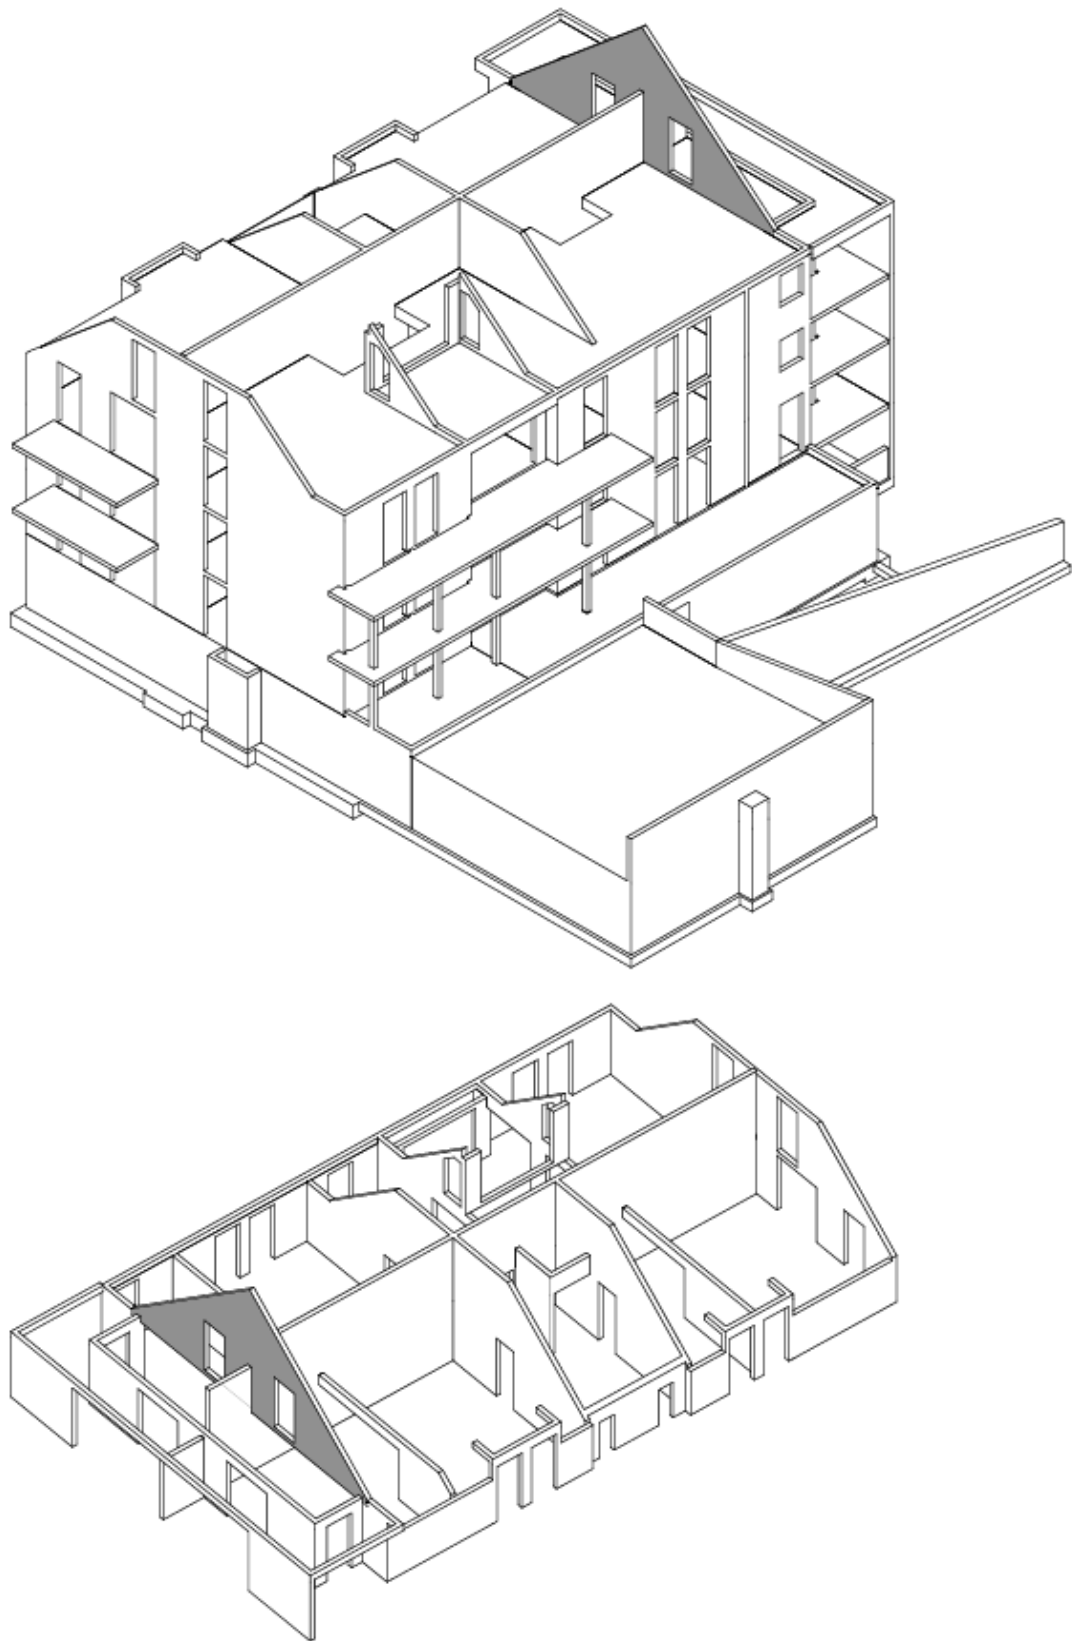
prédio e segundo andar mais andar da cobertura sem a laje baixa. Em destaque está o oitão em concreto armado (adaptado das plantas de fôrma do projeto estrutural)
